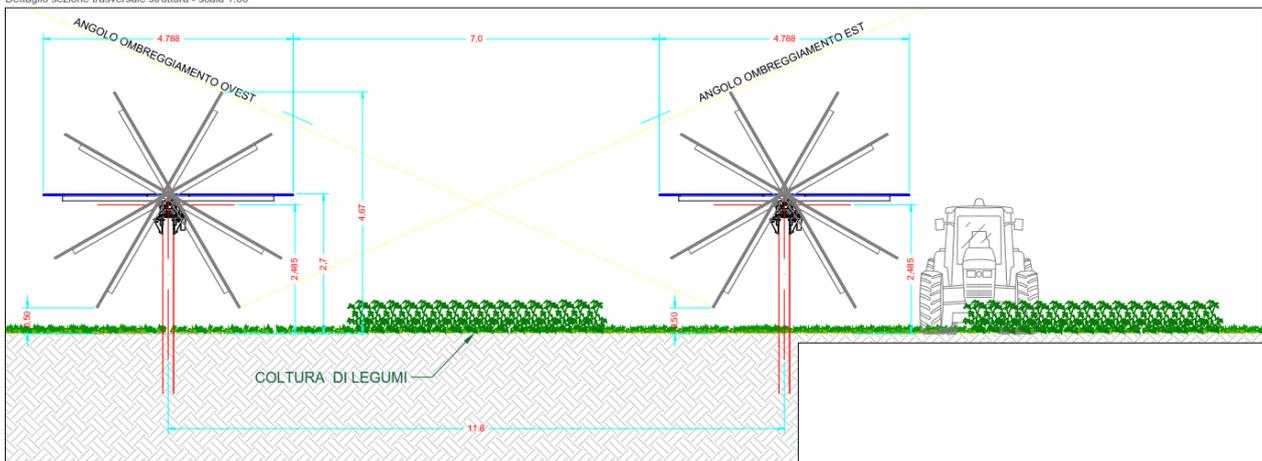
Particolare disposizione strutture di sostegno e spazio tra le file
